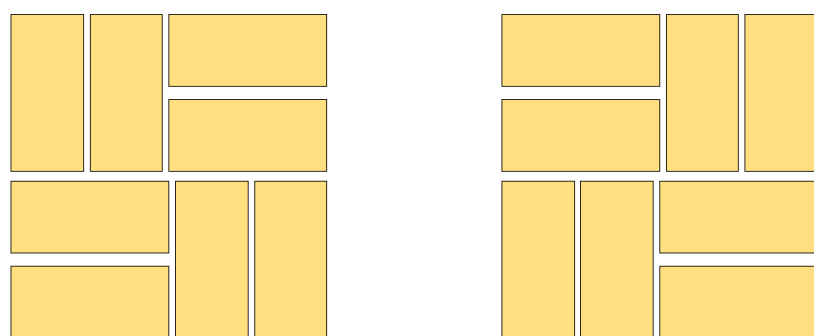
Detalle de la estructura de los ladrillos de los pilares (Fuente propia)
